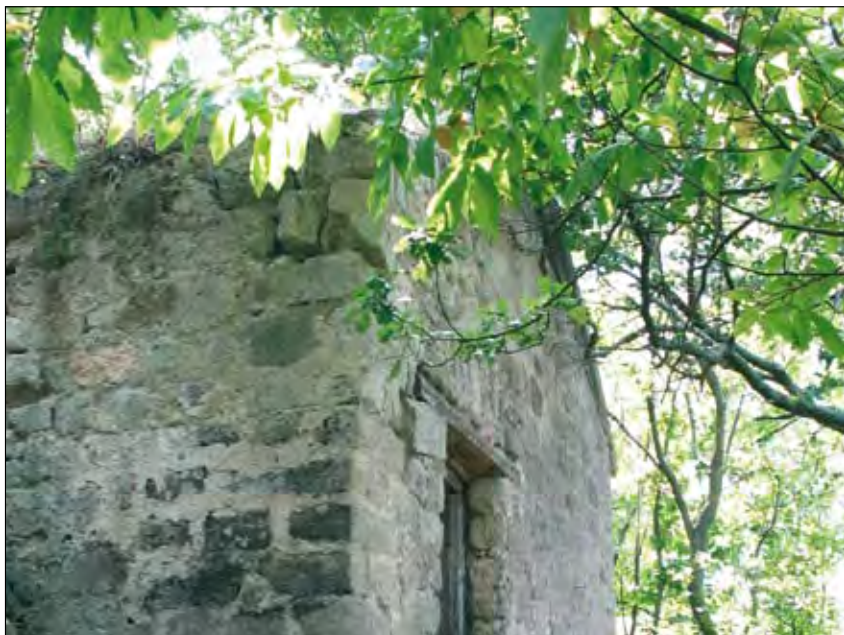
Piccolo fabbricato in tufo verde che riporta nelle murature, architrave e sottotetto inserti provenienti dalle vasche di lavorazione.
